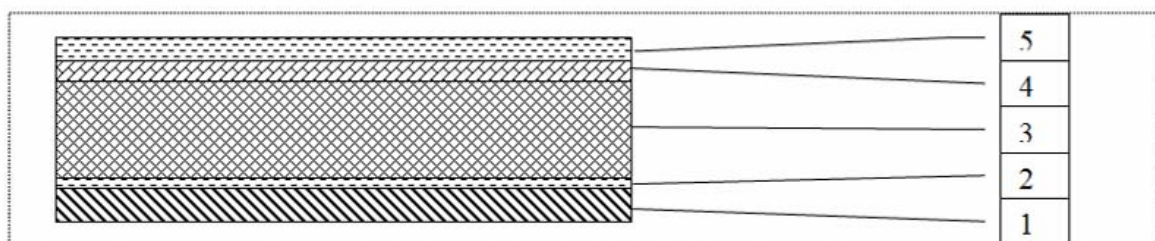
Схема кровельного настила с использованием традиционных теплоизоляционных материалов; 1-доски наката; 2-пароизоляционный слой; 3-теплоизоляционный слой; 4-стяжка; 5-гидроизоляционный слой
